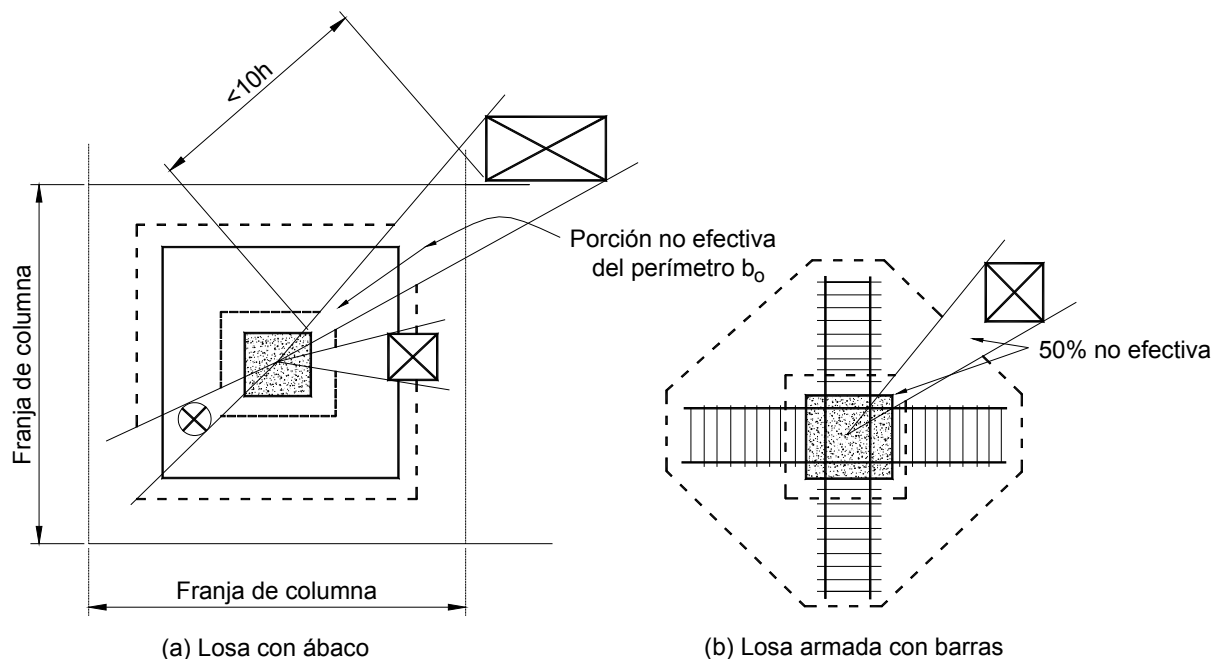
Efecto de las aberturas en las losas sobre la resistencia al corte
